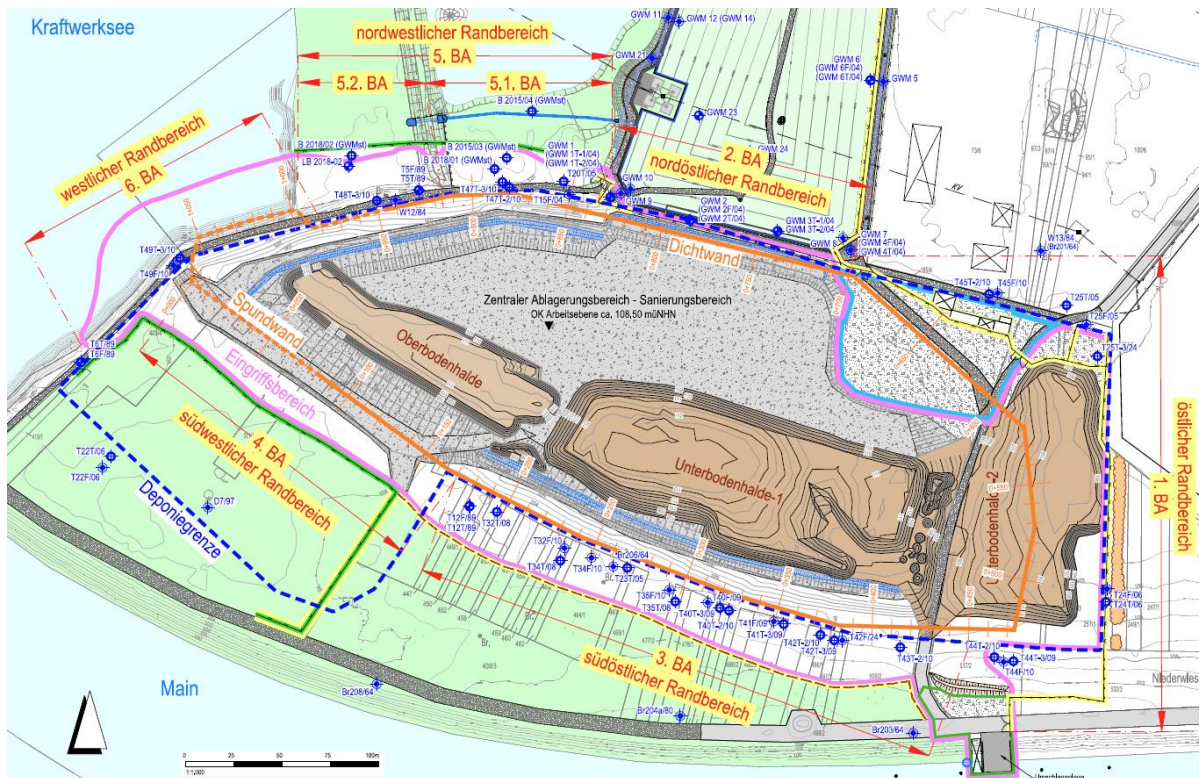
Übersichtslageplan der Bauabschnitte zur Errichtung des Randdamms
